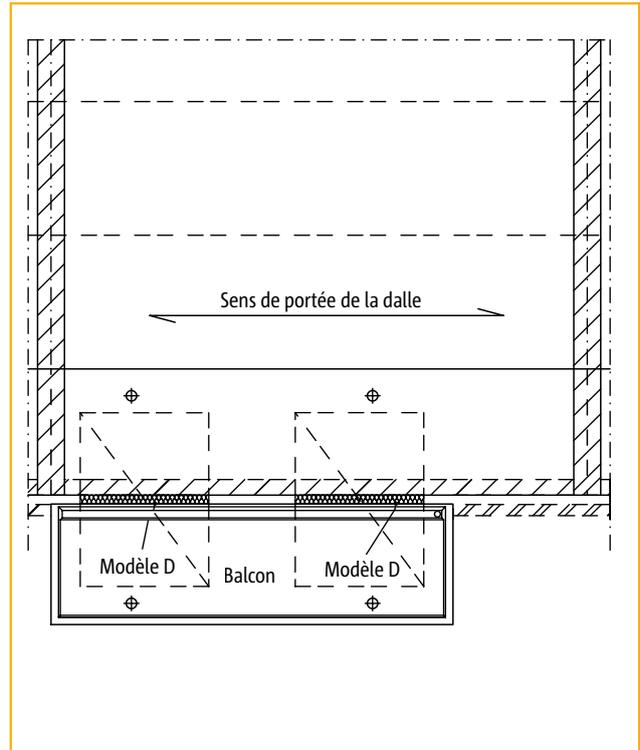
Éléments en béton préfabriqués associés au rupteur Schöck Isokorb®
